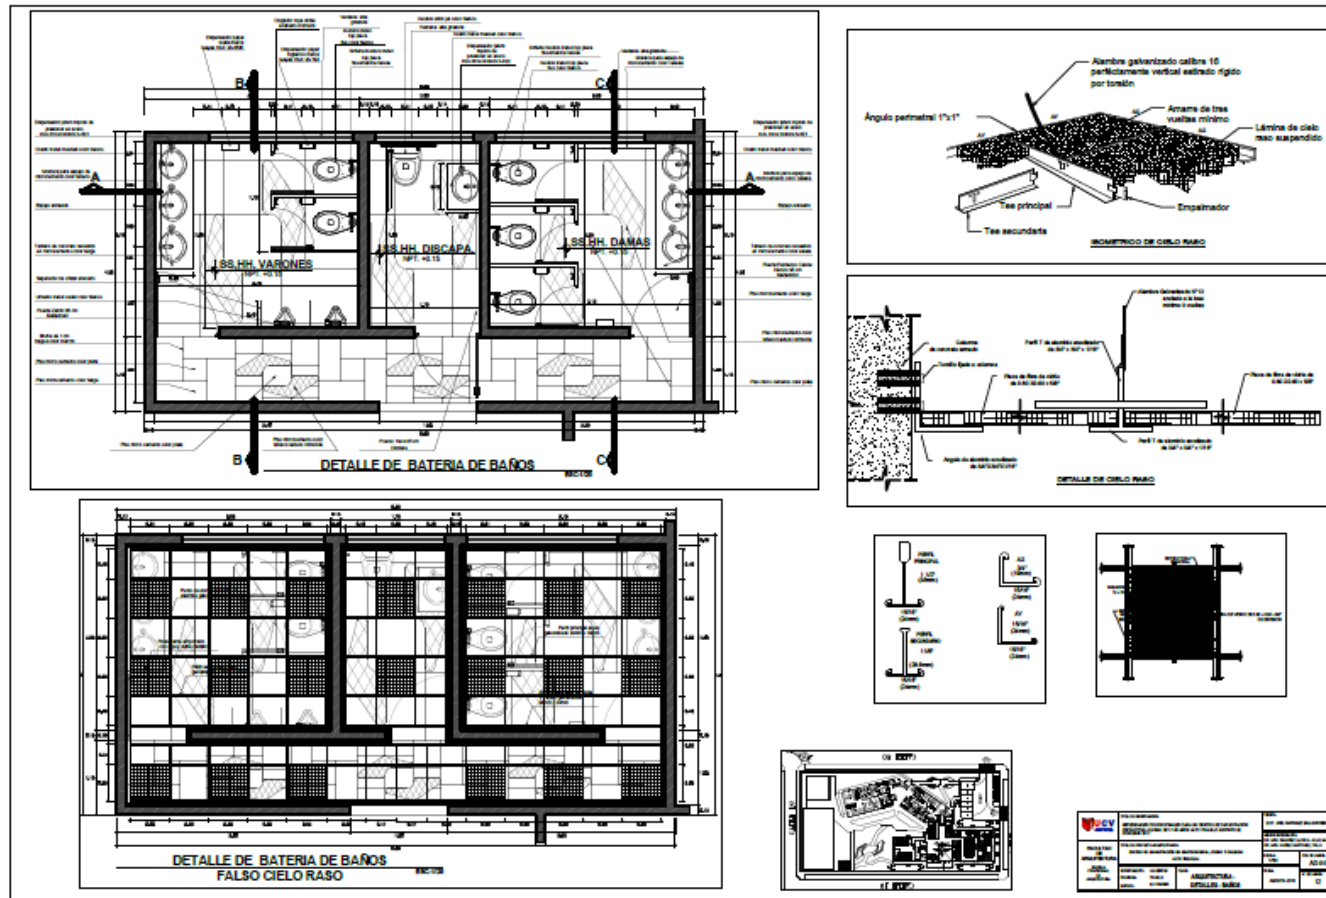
Plano de Detalle Arquitectónico, Planta y falso cielo raso de baños-Plano N°12-Lámina AD04
